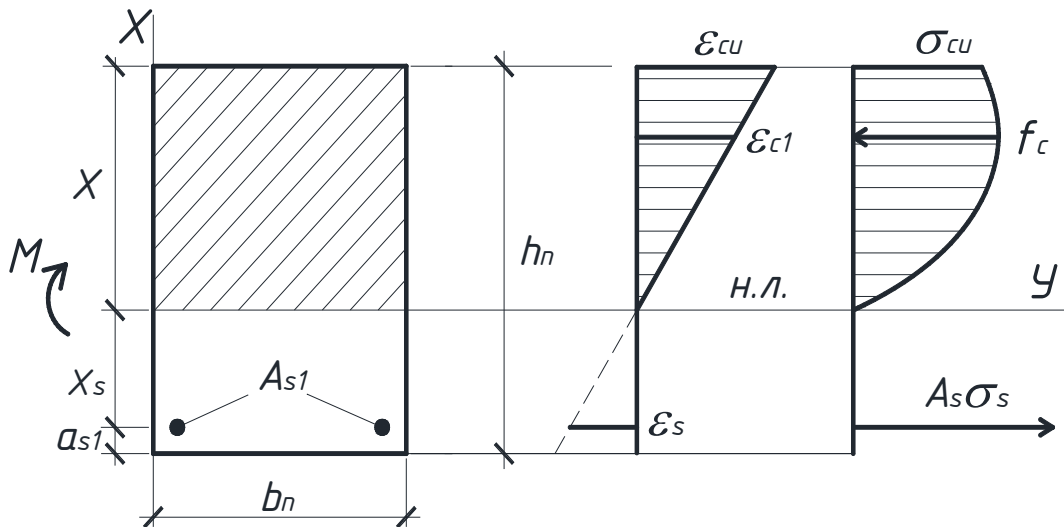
Розрахункова схема перерізу залізобетонної балки № 4 [462]
